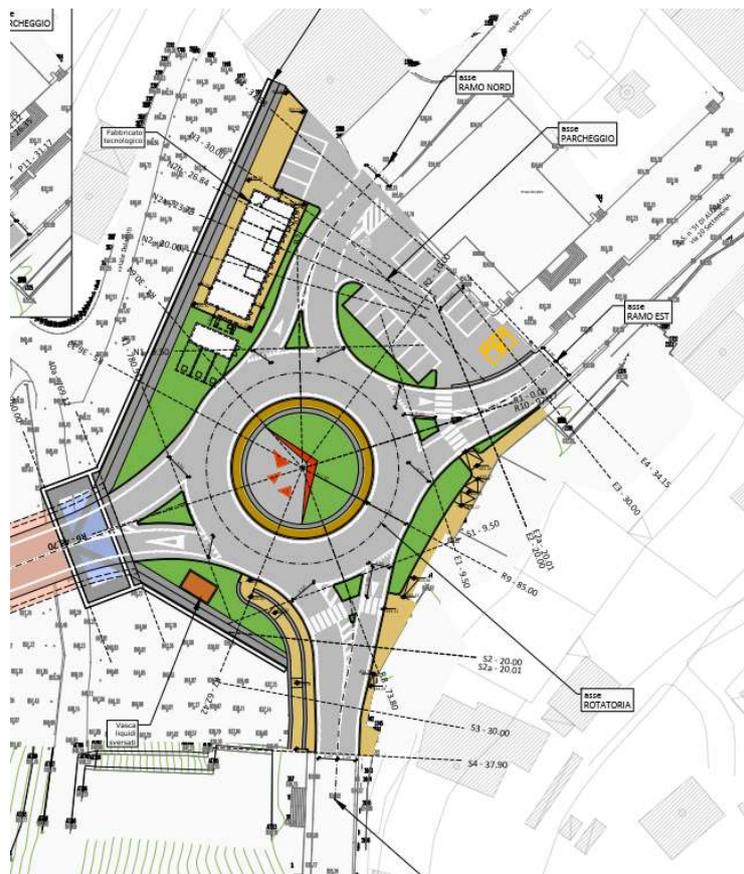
Planimetria di progetto – Imbocco Ovest
